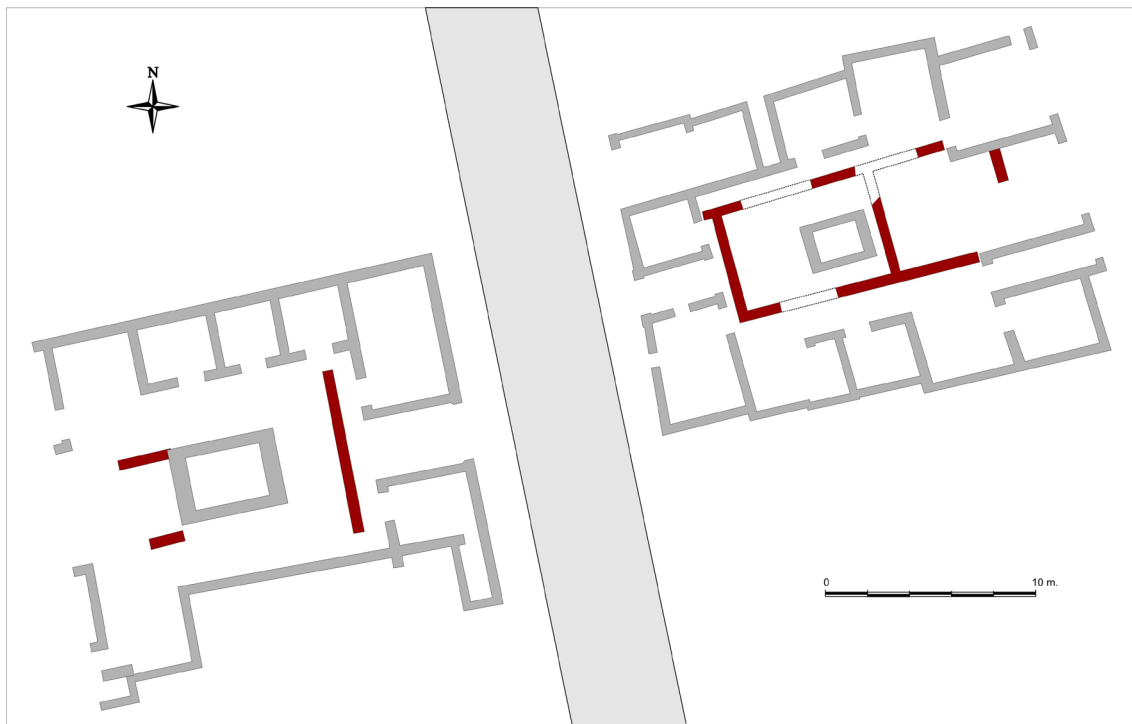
Plano de las estructuras excavadas en Pompeya por Maiuri (a partir de Maiuri 1973: fig. 88 y fig. 90).
